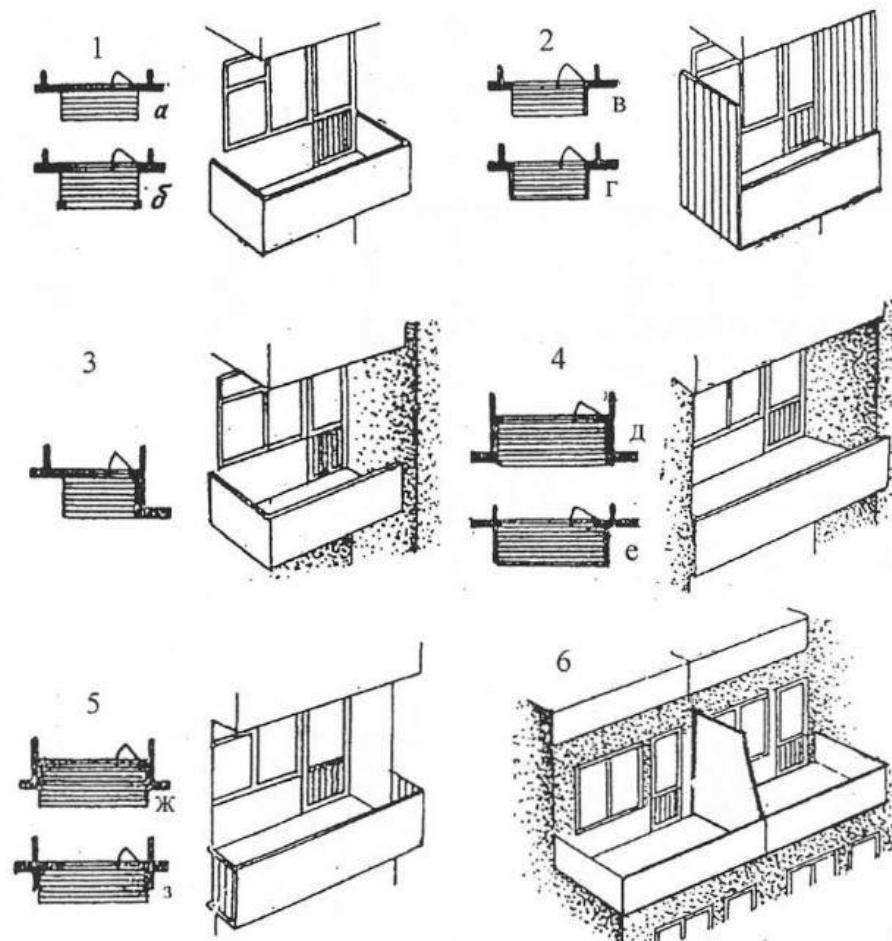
Типы летних помещений: 1-открытый балкон (а – консольный, б – на столбах); 2 – балкон с ветрозащитными экранами с одной (в) или двух (г) сторон; 3 – угловой балкон; 4 – лоджия (д – заглубленная, е – выступающая); 5 – лоджия – балкон (ж – полузаглубленная, з- примыкающая к фасадной плоскости); 6 – терраса
